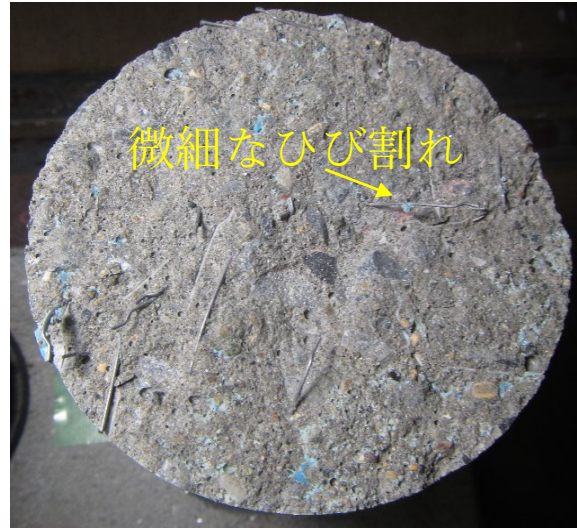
ひび割れ部④の拡大断面図
